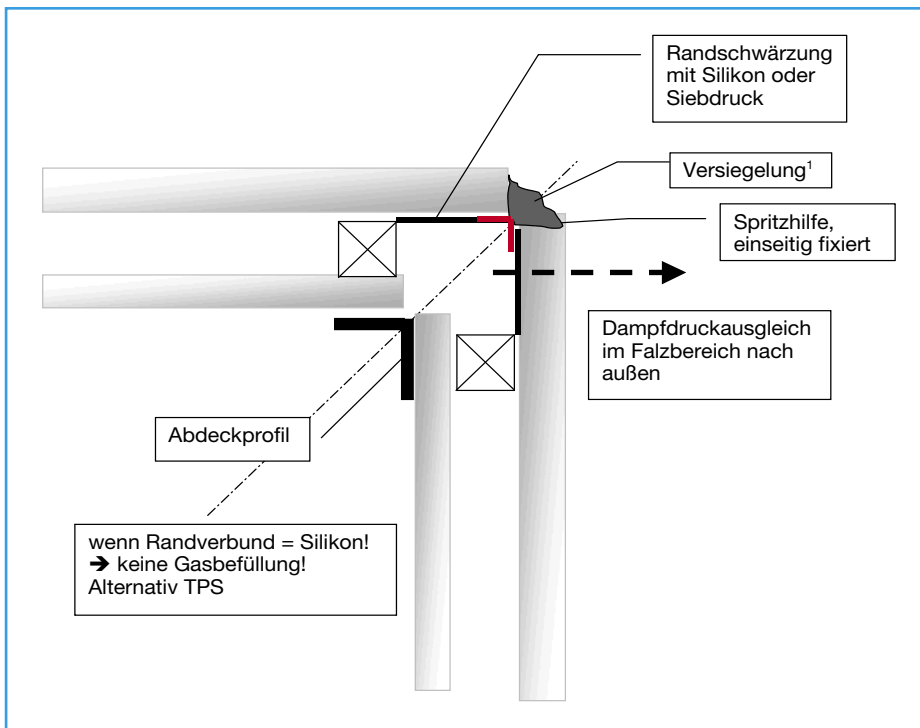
Isolierglas-Außenecke ohne Rahmen: Die folgende Ausführungsvariante wird unter Verwendung einer Montagehilfe hergestellt
